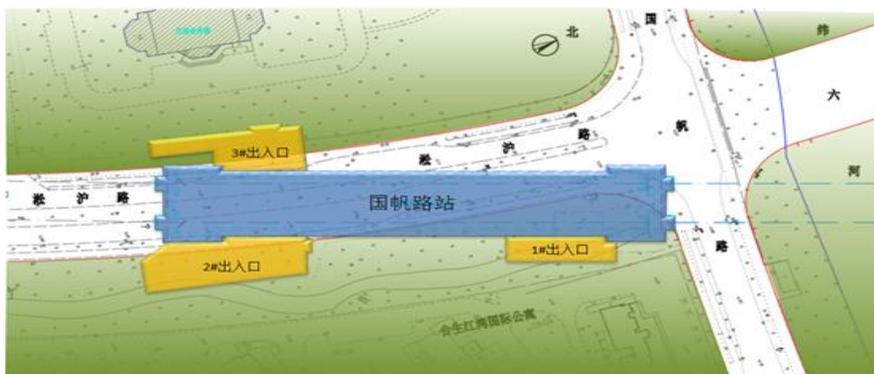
上海市轨道交通 10 号线二期 1 标段国帆路车站总平面图
